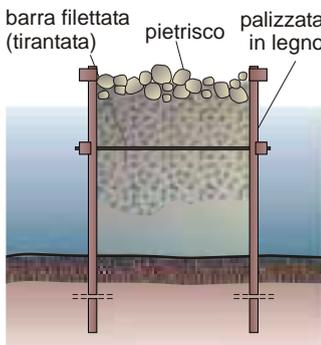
Pennello impermeabile con tavole e pali in legno trattati. Questo tipo di struttura è indicato per paraggi non soggetti a forte ondatazione e necessita di una buona infissione degli elementi nella sabbia e di un buon trattamento impermeabilizzante per il legname.
